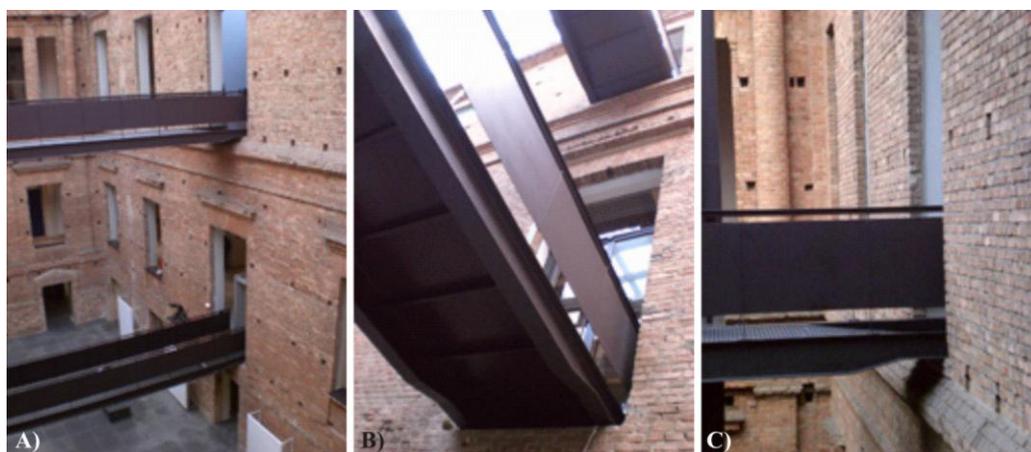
A) vista geral das passarelas; B) detalhe apoio do 1º pav.; C) detalhe apoio do 2º pav.
